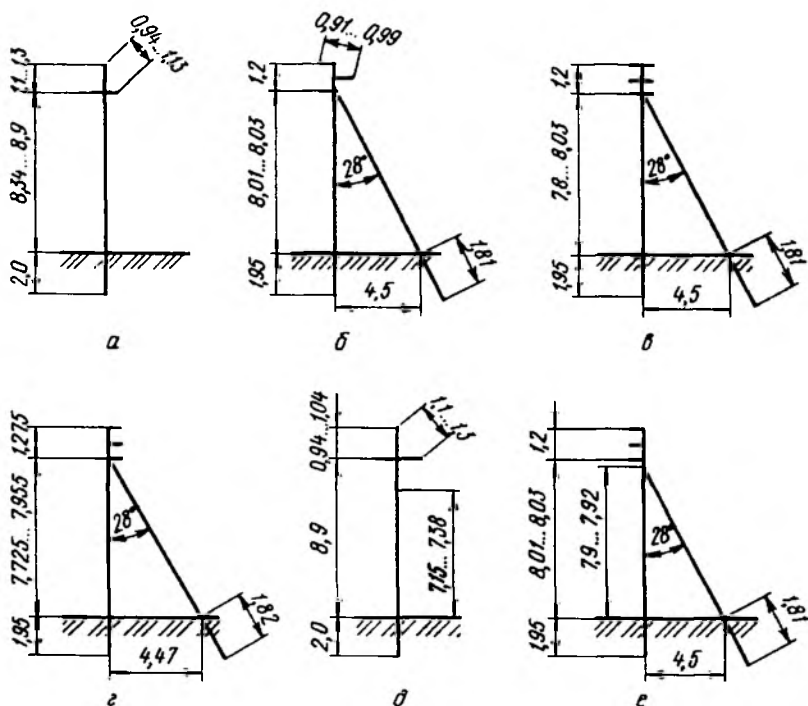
Схемы железобетонных опор ВЛ напряжением 6...20 кВ (размеры даны в метрах):
